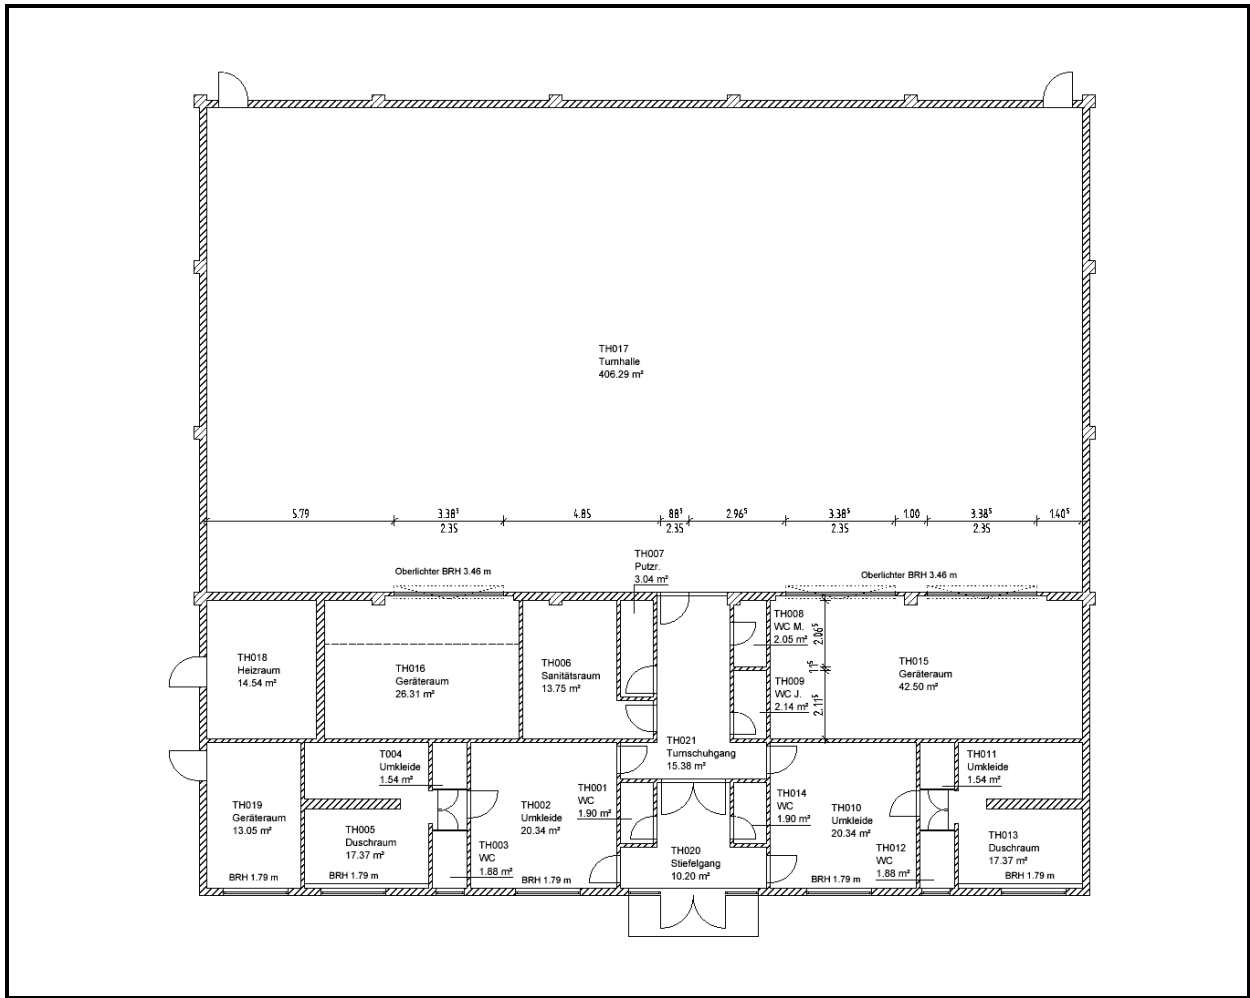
Deutscherrenschule: Grundriss Erdgeschoss Turnhalle
